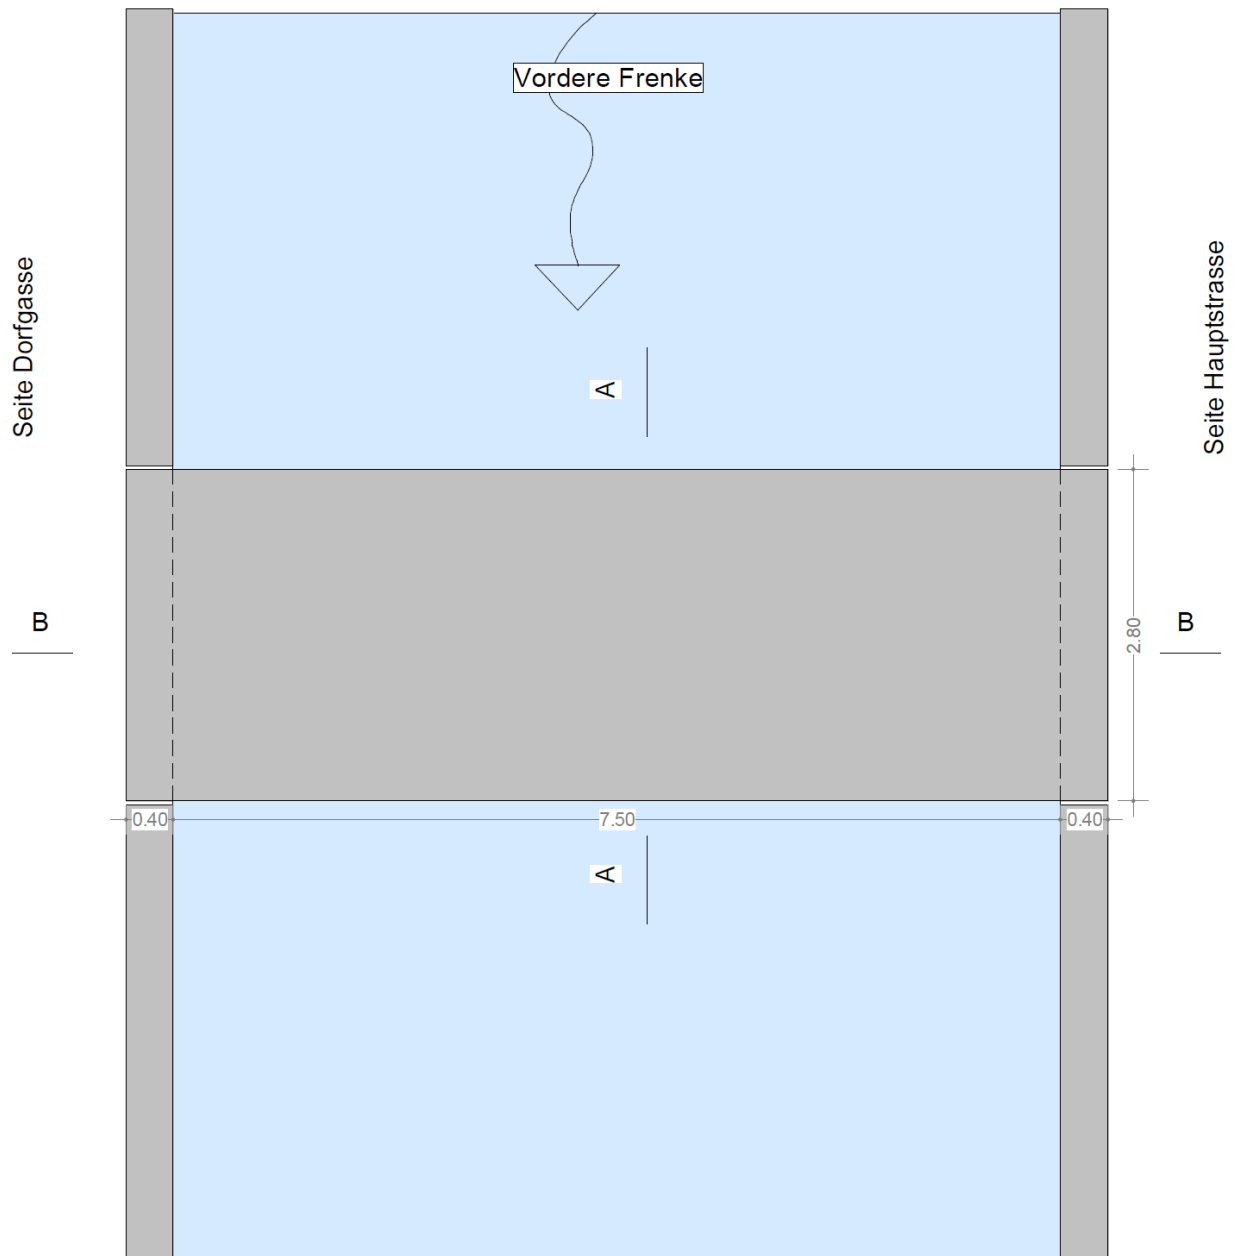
Skizze Grundriss der Brückenplatte
